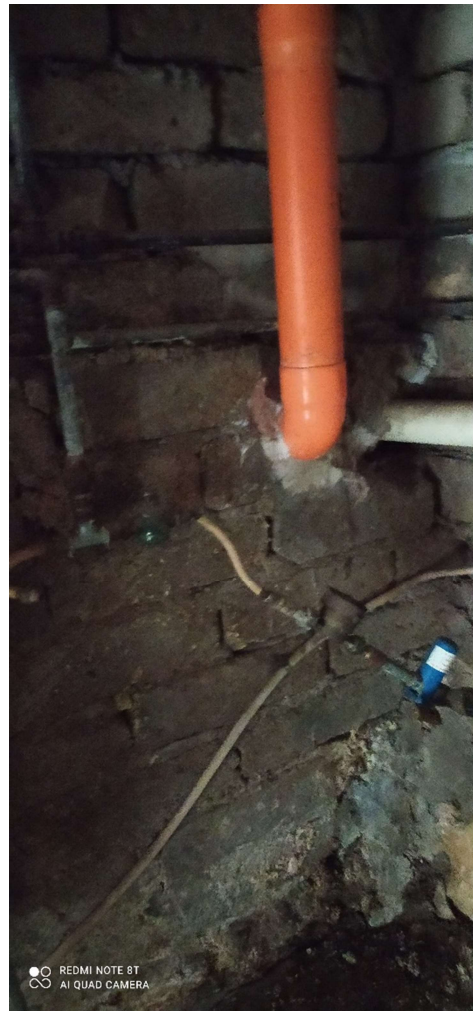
sub 8 – deposito utilizzato come locale tecnico
